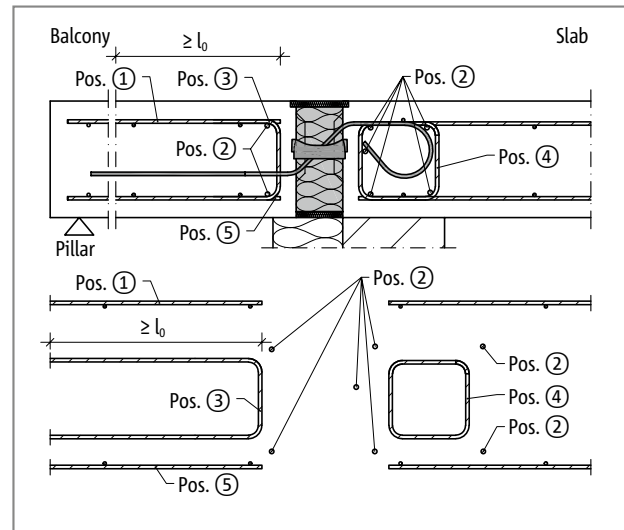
Schöck Isokorb® T type Q-E-W-V: On-site reinforcement
